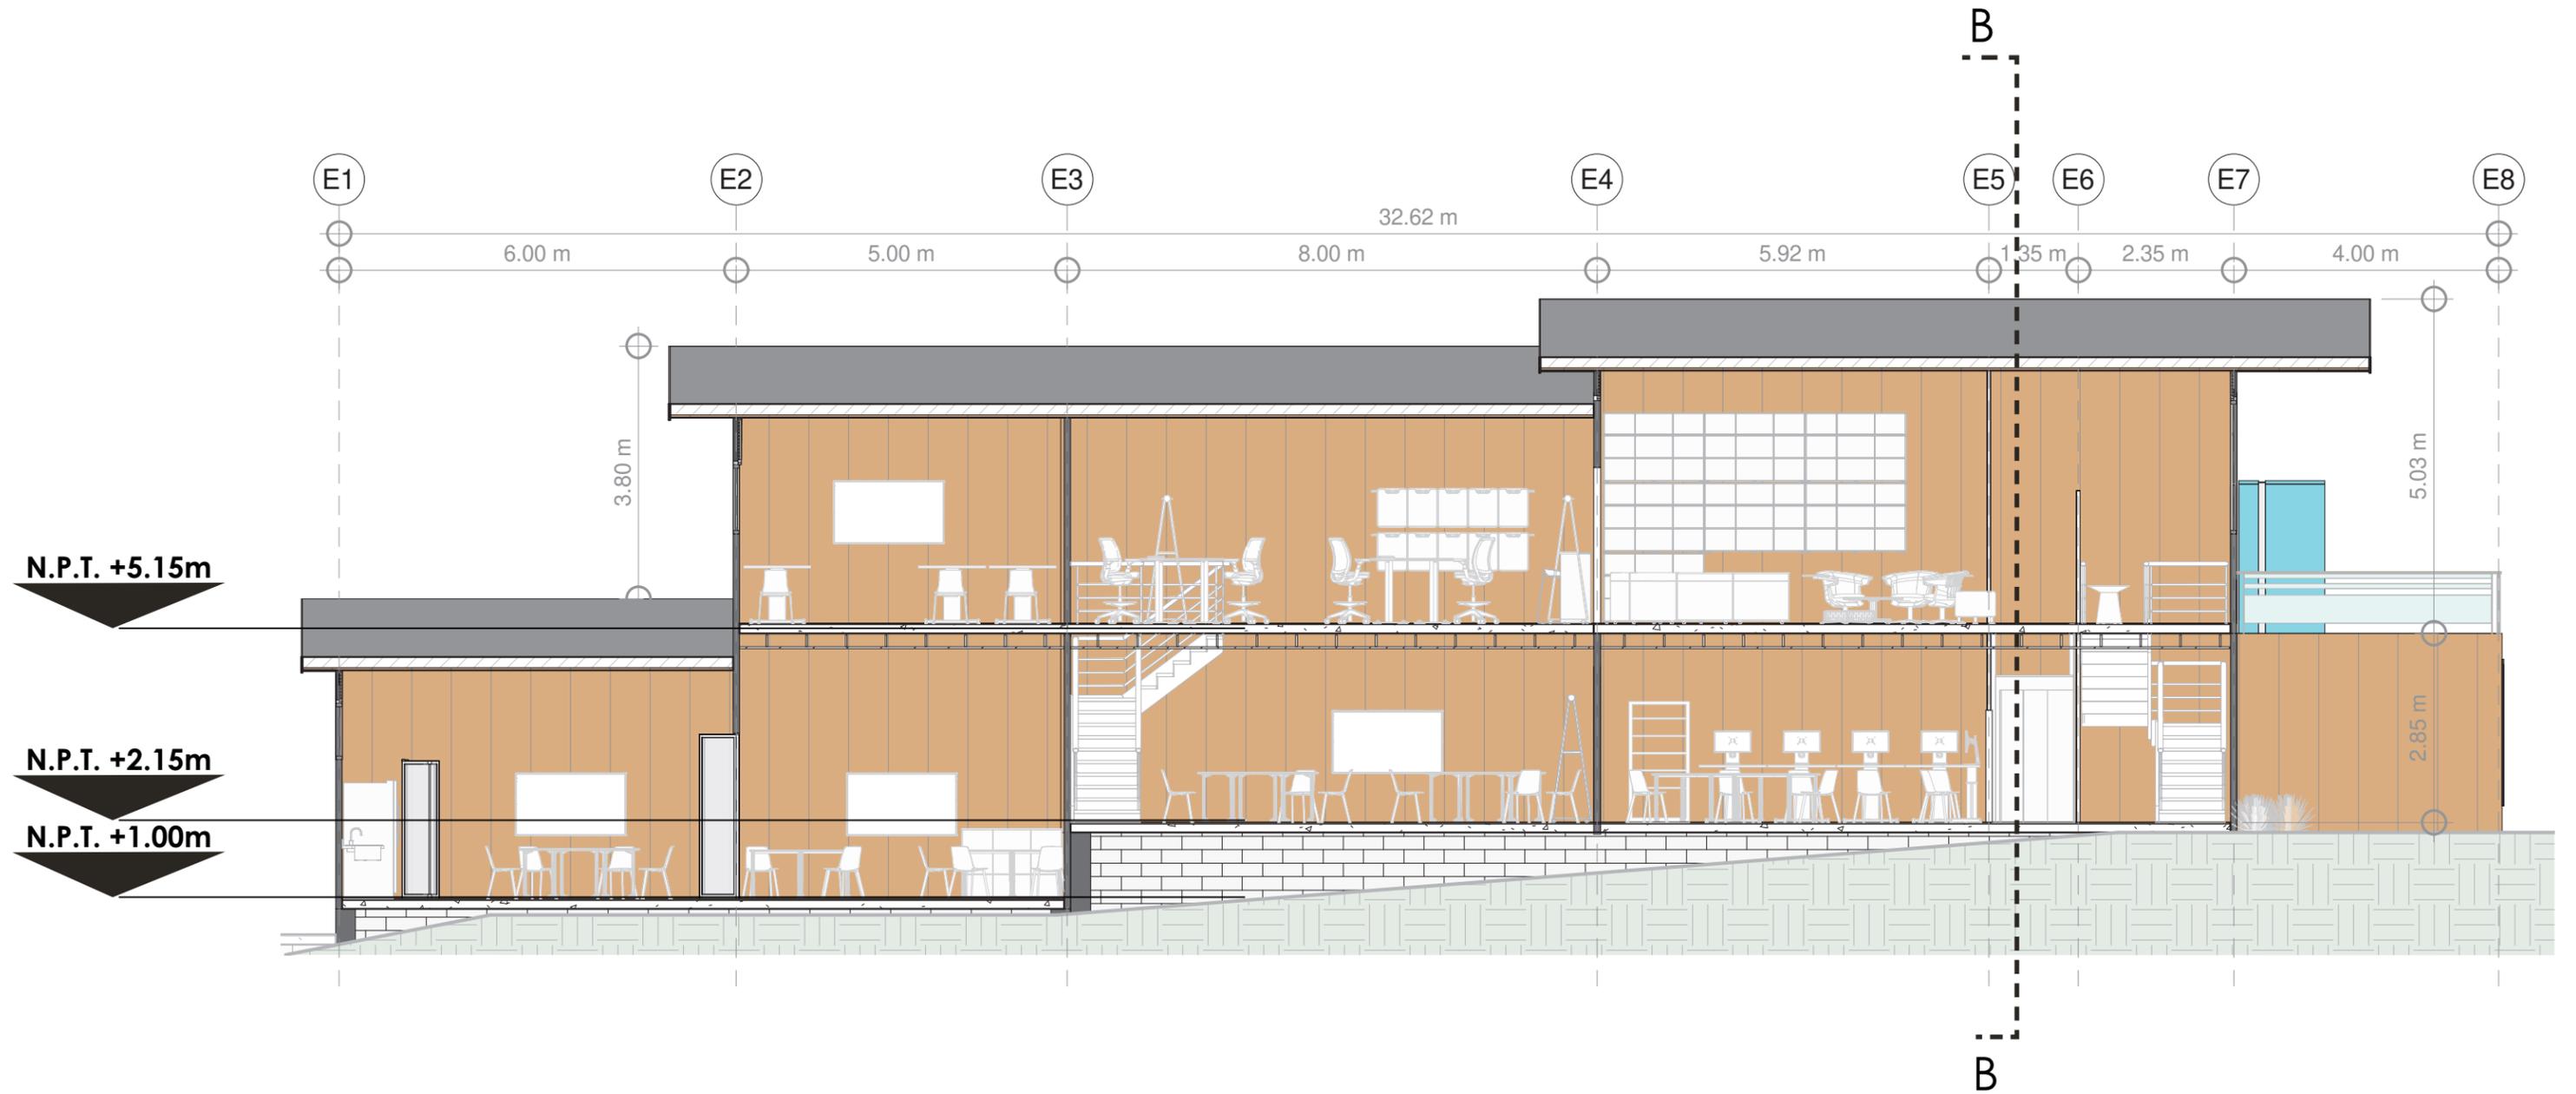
Sección A-A de bloque educativo. Fuente: Propia.
